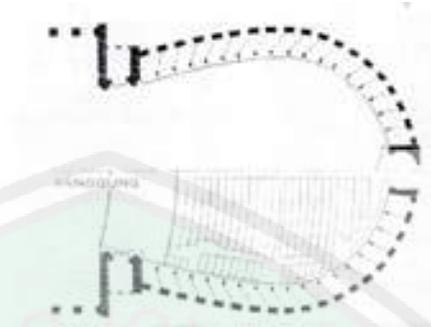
Visualisasi Layout Gedung Pertunjukan Tipe Kipas
